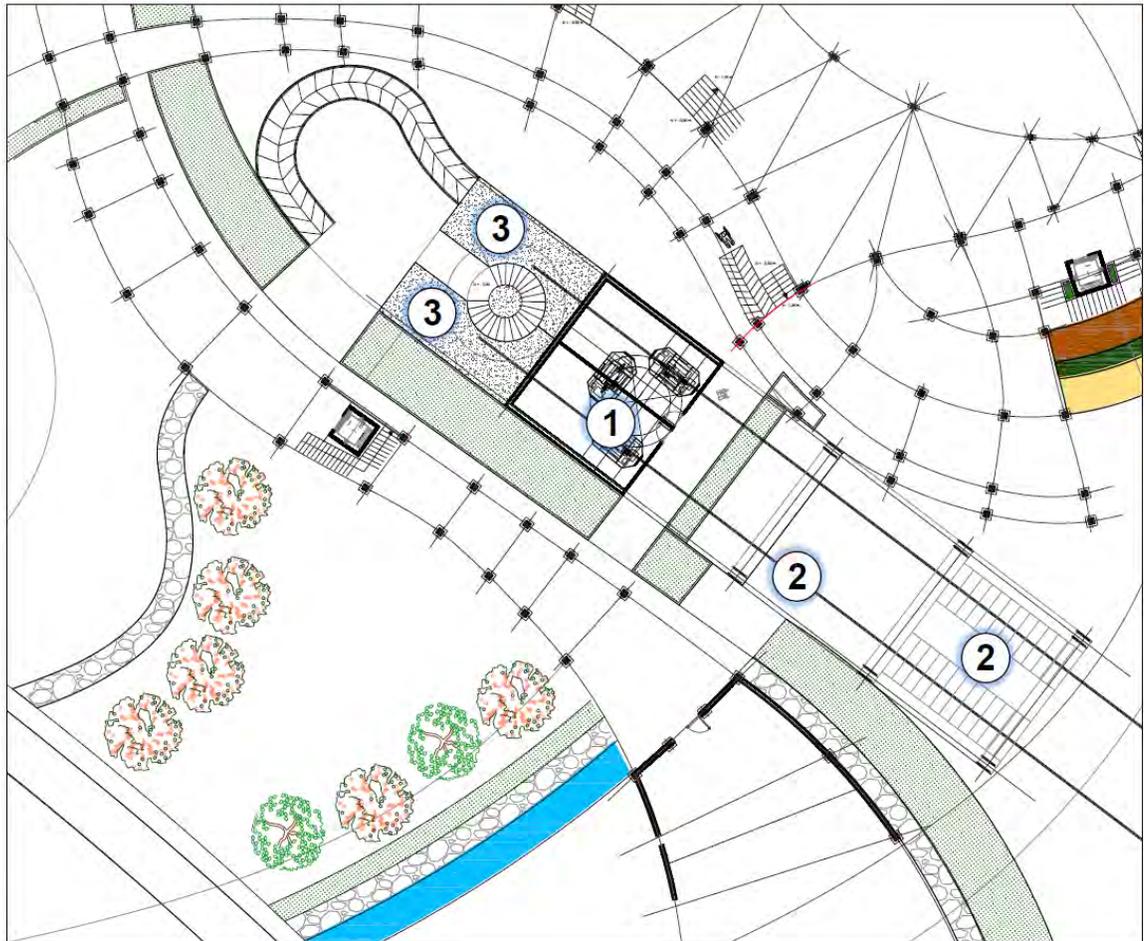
Detalle teleférico del proyecto, planimetría arquitectónica
